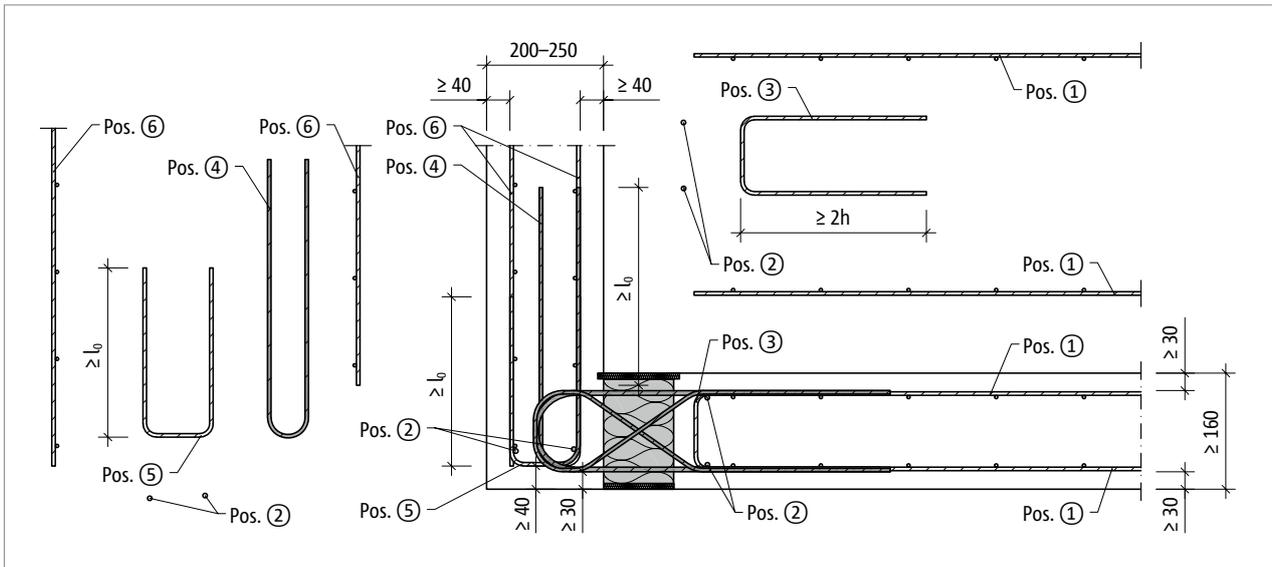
Schöck Isokorb® XT/T Typ F: Bauseitige Bewehrung bei Brüstungsbreite  $b = 200-250$ ; Bauseitige Bewehrung  $b = 160-190$  wie  $b = 200-250$  ohne Pos. 5
